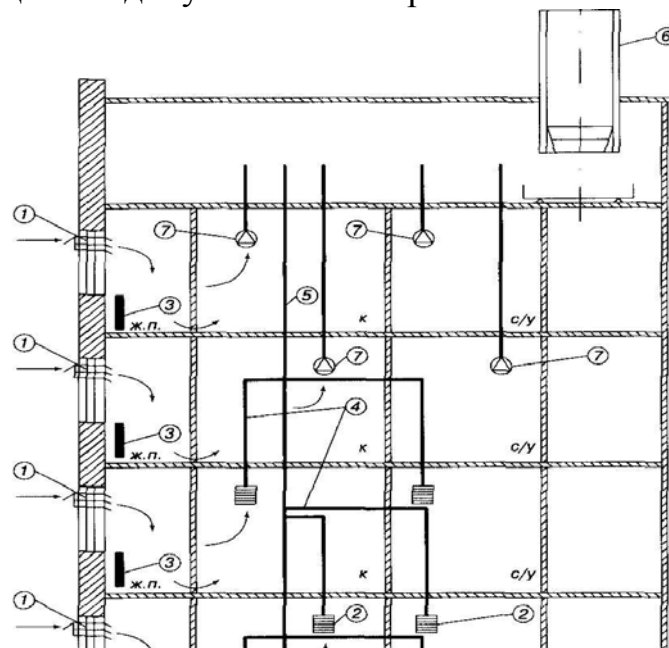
Схема вентиляции с отдельными и общим сборным вытяжными каналами в здании с теплым чердаком
